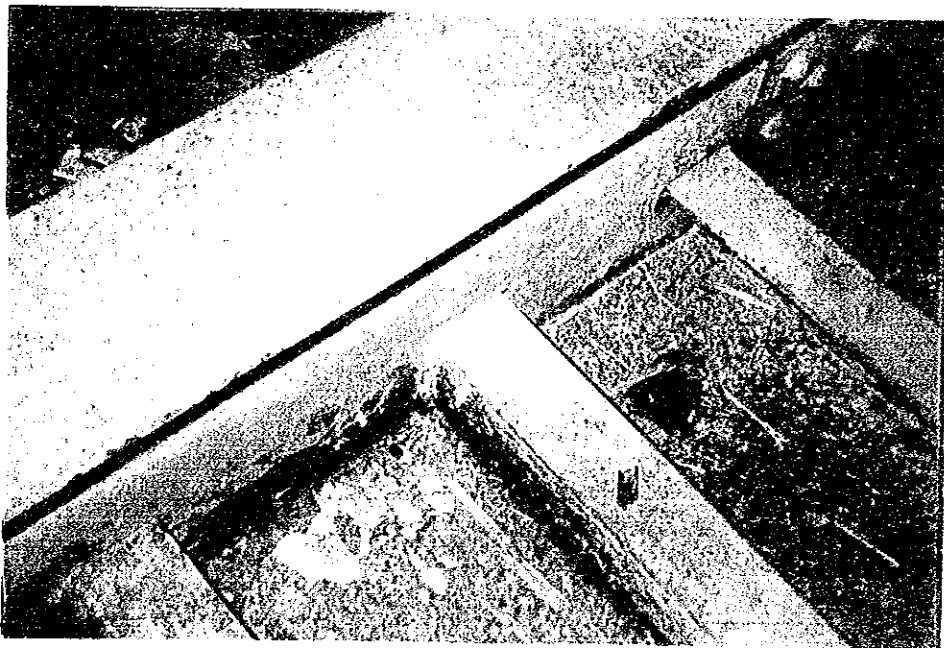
既設鋼箱桁内部下フランジおよびリブの錆
